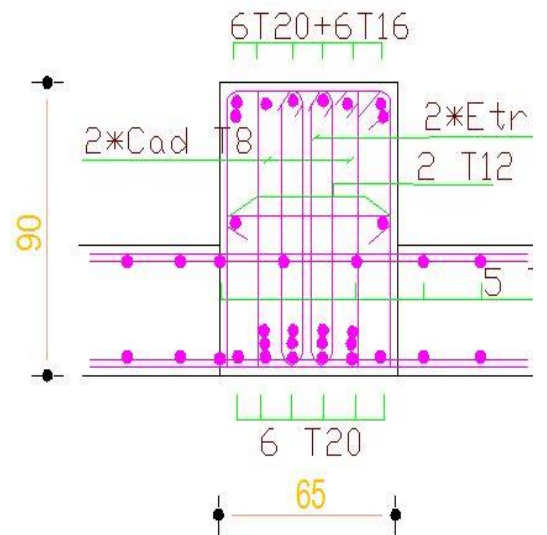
Le ferrailage de la poutre de la dalle sens Y-Y.
